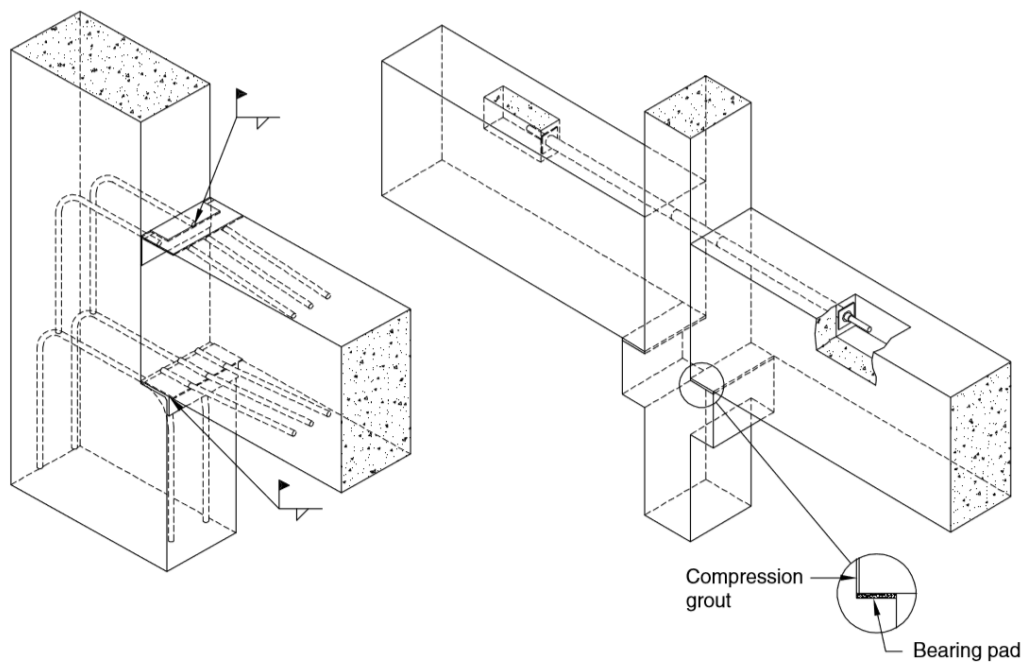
Conexiones con elementos prefabricados, Izq: Conexión rígida soldada der: Conexión articulada. [1]
